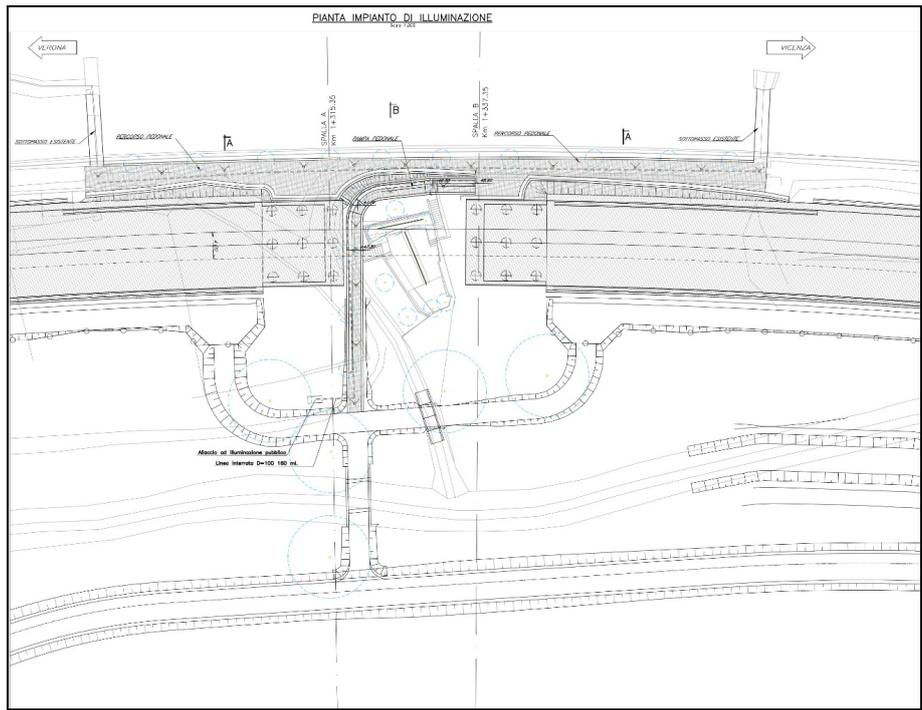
Pianta impianto di illuminazione (stralcio Tav. IN1711EI2PZVI1907001A - Planimetria e dettagli impianto di illuminazione)
